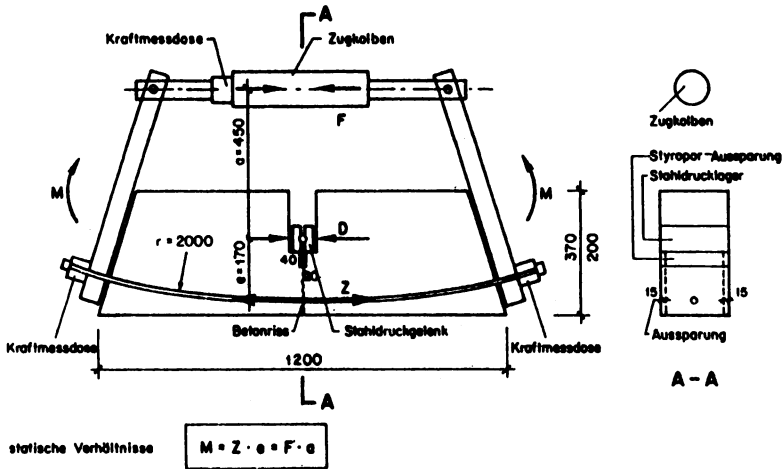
Schema des Kleinkörpers und seiner Belastung
